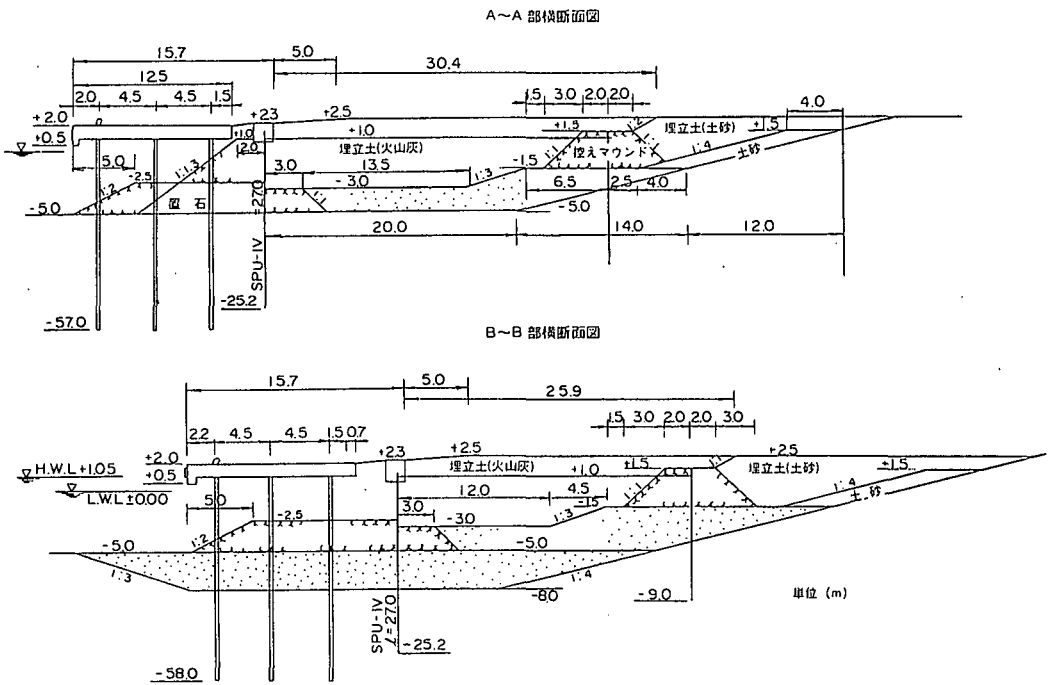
函館港豊川地区豊川埠頭岸壁 (-5.0 m) 標準断面図
